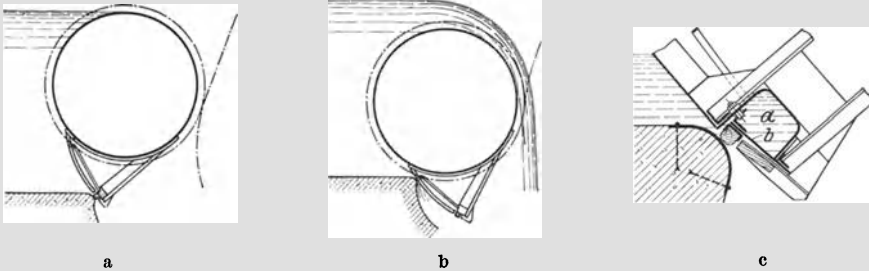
a bis c. Versenkbare Walze der M.A.N.
